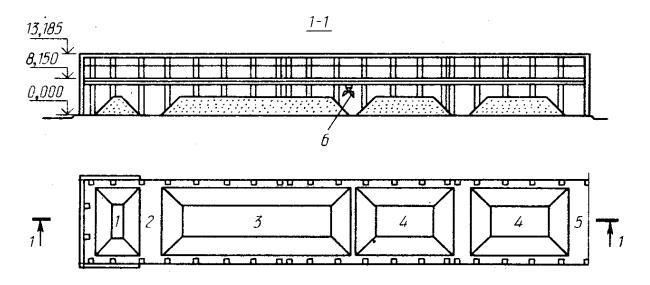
Типовое сооружение компостирования осадка: 1 — закрытая площадка для хранения присадочного материала; 2—площадка для погрузки готового компоста; 3 — площадка дозревания; 4—площадка компостирования; 5 — площадка смешения осадка с присадочным материалом; б — кран.
